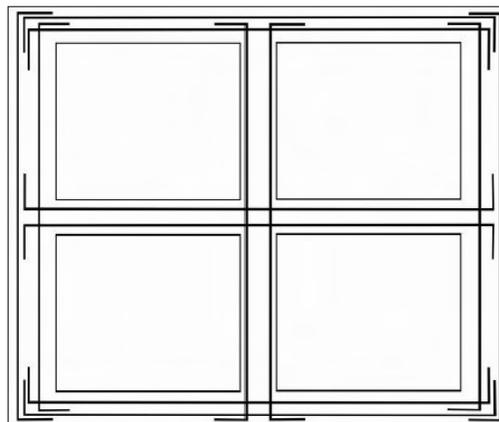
Figura E.2.1-2 Ganchos de anclaje en vigas de cimentación transversales
